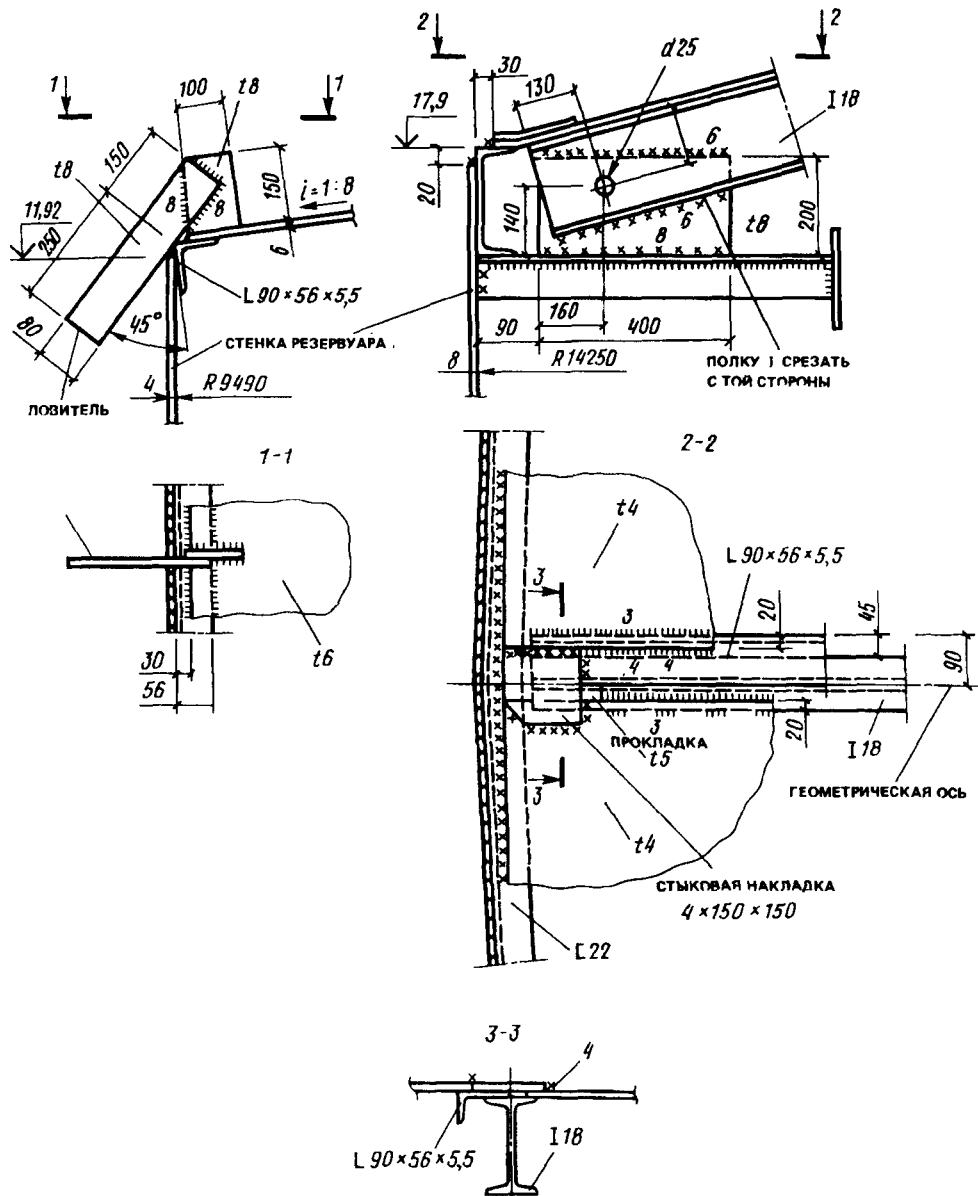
Узел сопряжения конической крыши и стенки резервуара
